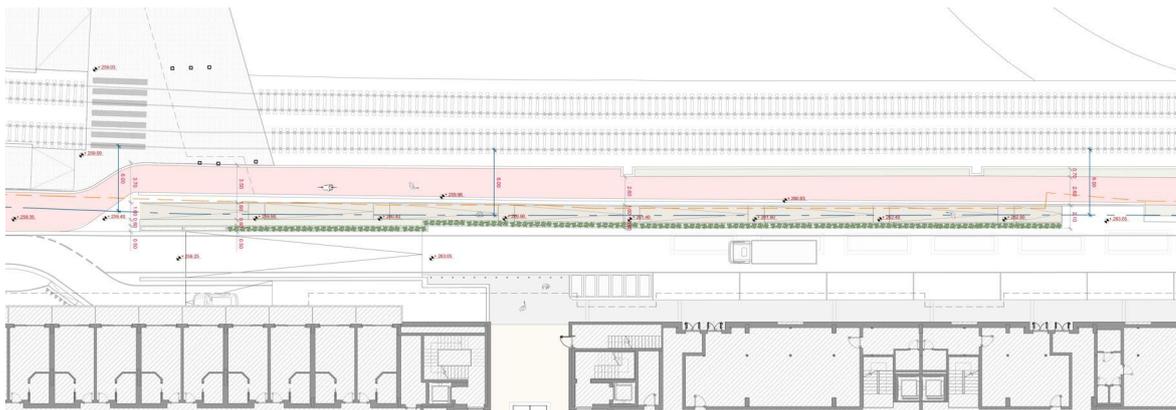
NUOVA RAMPA – STAZIONE TEB
